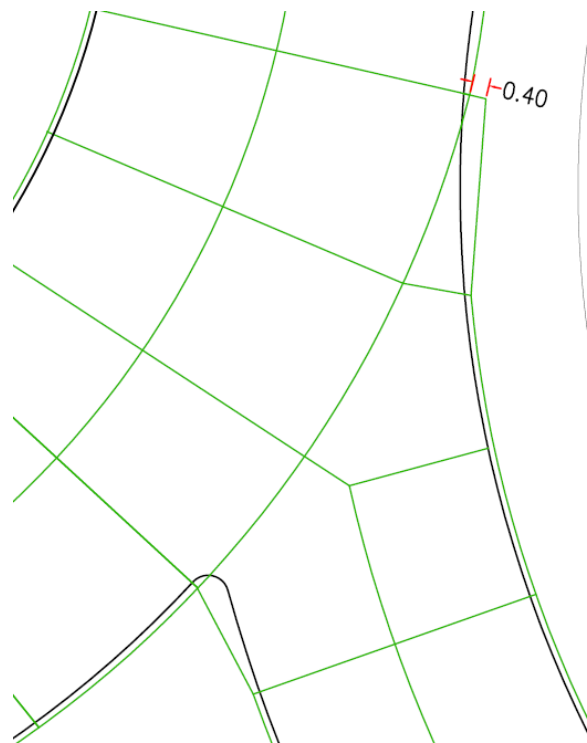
Modulación de losas de  $H^0$  en intersección de la rotonda y ramal entrante sureste.
